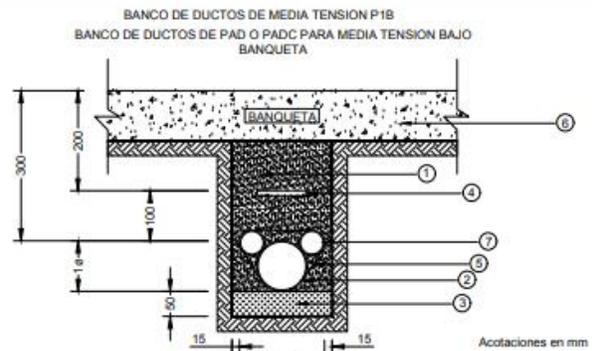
Detalle arquitectónico de la instalación eléctrica subterránea.
